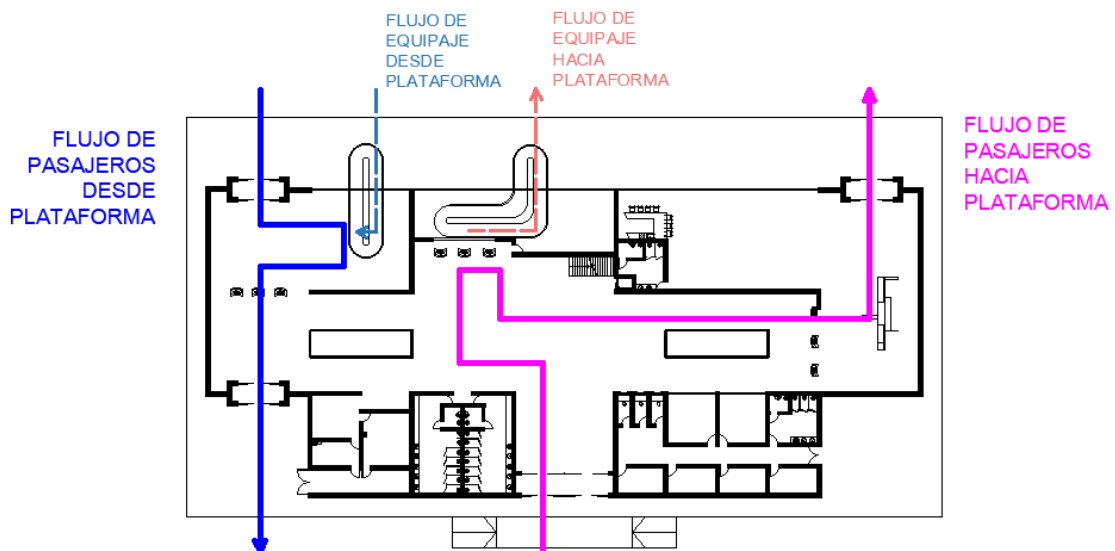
Circulaciones en planta baja. Fuente: Elaboración propia
